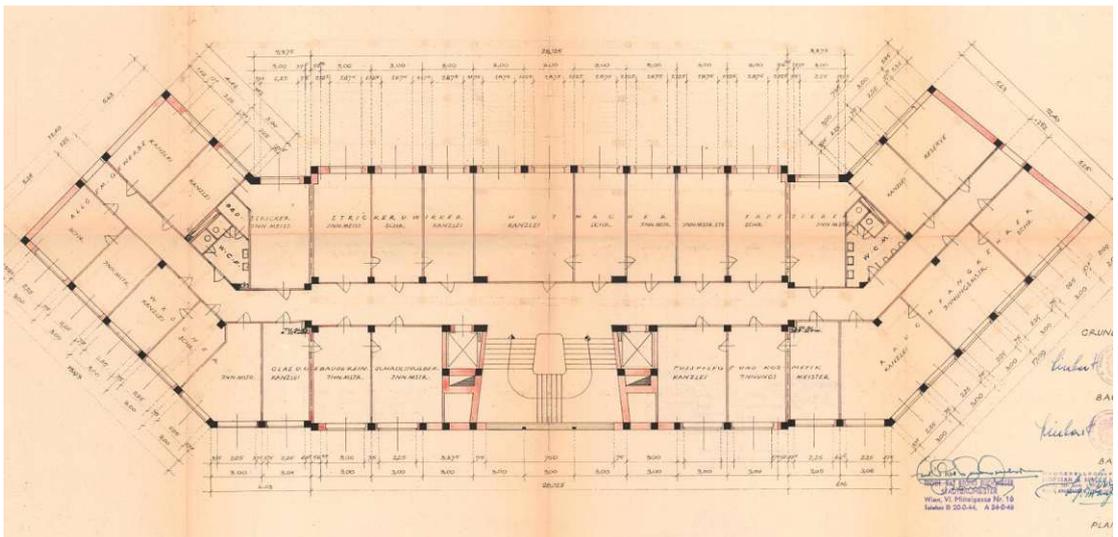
Grundrissplan Regelgeschoss
